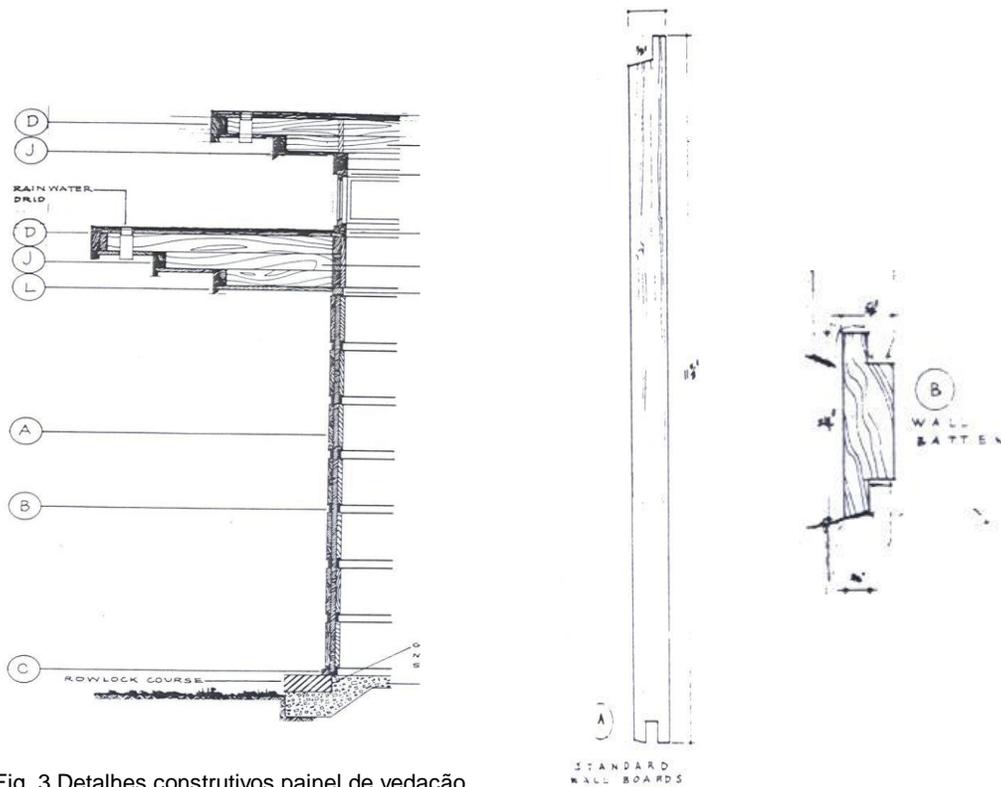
Detalhes construtivos painel de vedação Casa usonianas. Ao lado, a tábua e a junta
